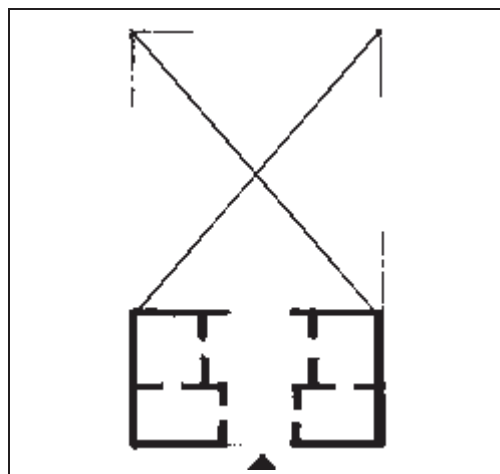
Planta arquitectónica de la serie de viviendas construidas en la calle 52 entre 53 y 55.
